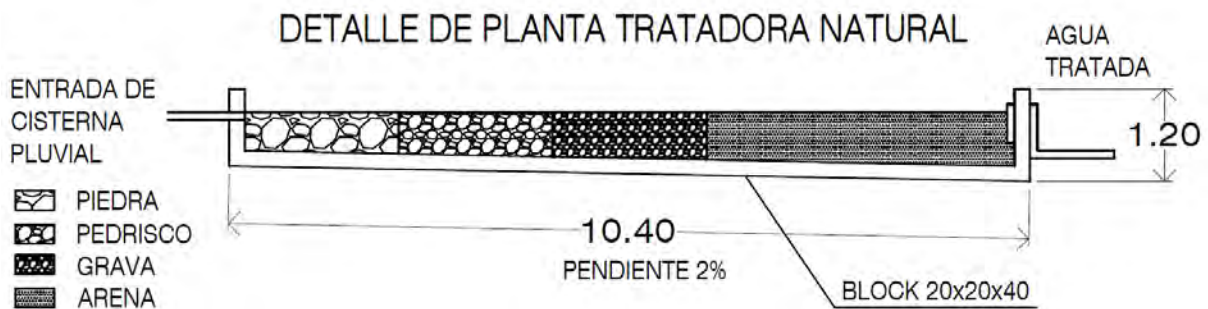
Detalle de planta tratadora natural a base de filtros de piedra
